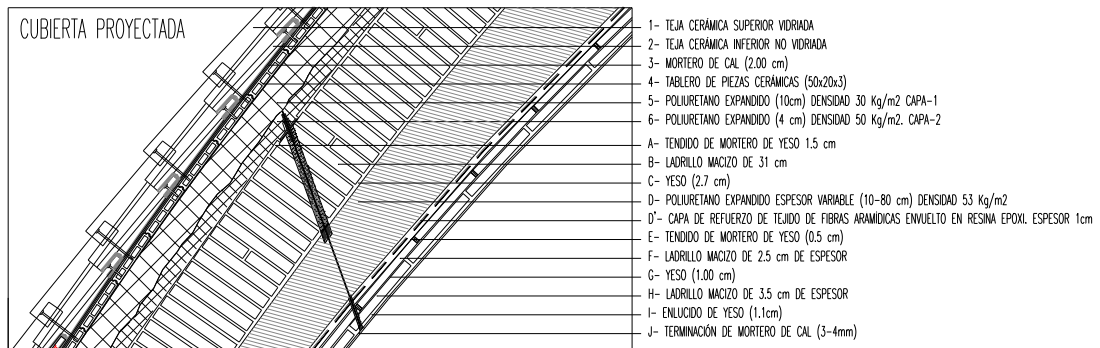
Sección constructiva de la cubierta proyectada. Basilica de la Virgen.
